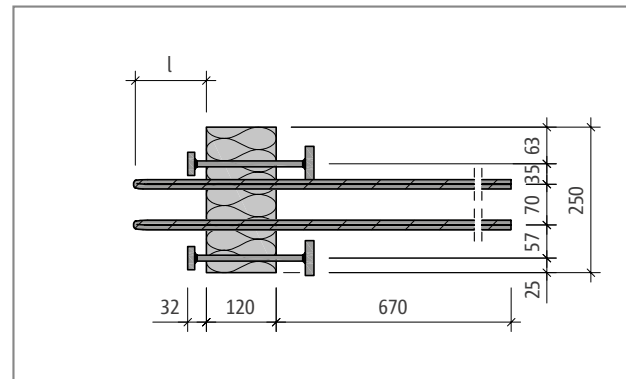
Schöck Isokorb® XT Typ O: Produktgrundriss
